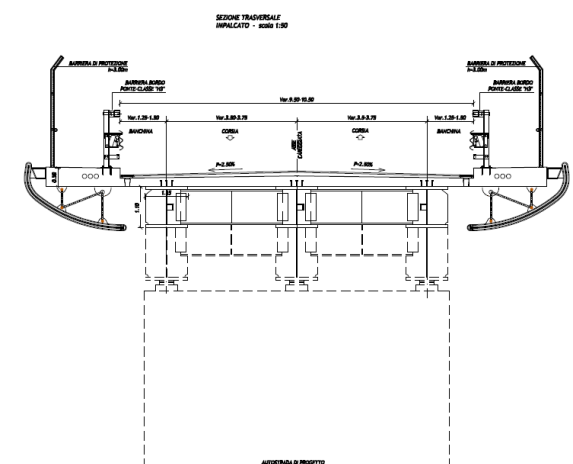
SEZIONE TIPO IMPALCATO CAVALCAVIA DI STRADA PROVINCIALE
